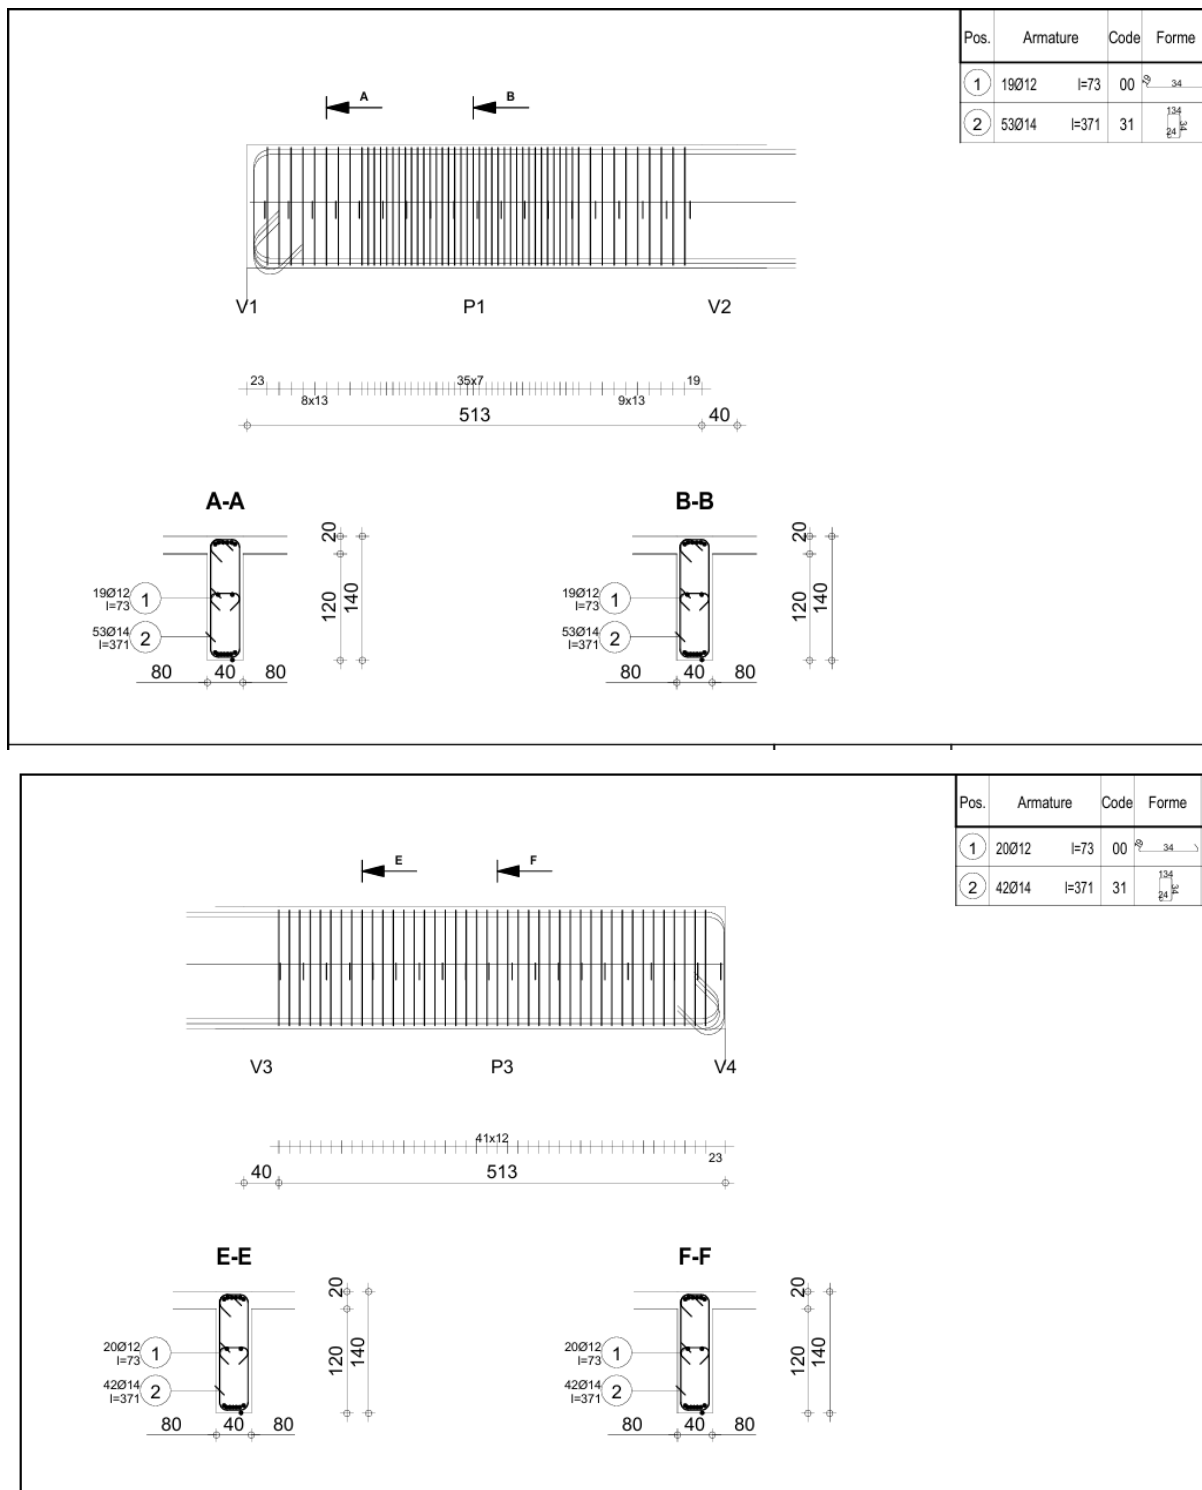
37 - Plans des ferrillages de la maitresse poutre par la MEF.
